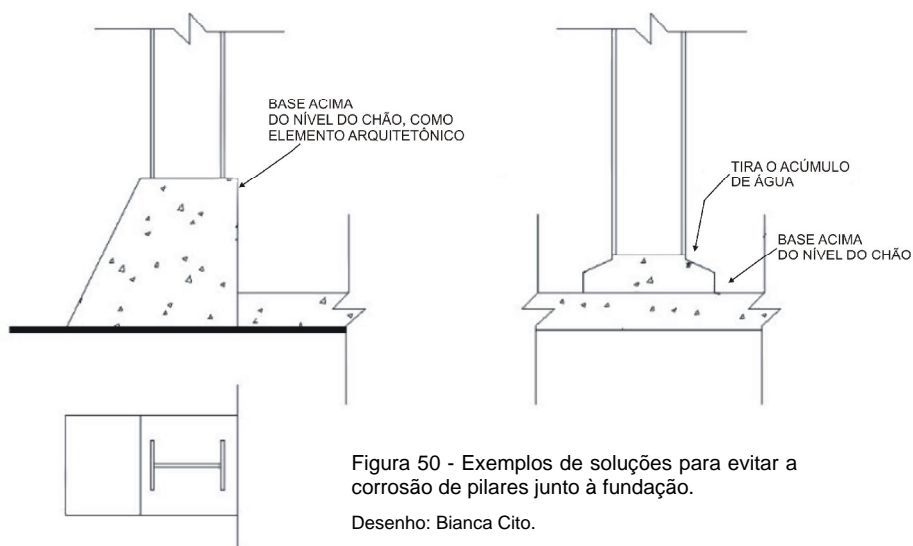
Exemplos de soluções para evitar a corrosão de pilares junto à fundação.
